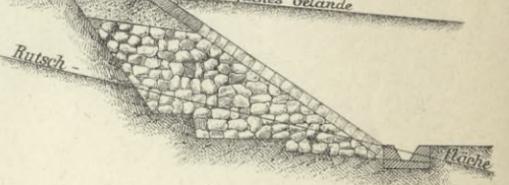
Stützmauer und Fanggraben. M. 1:200.
